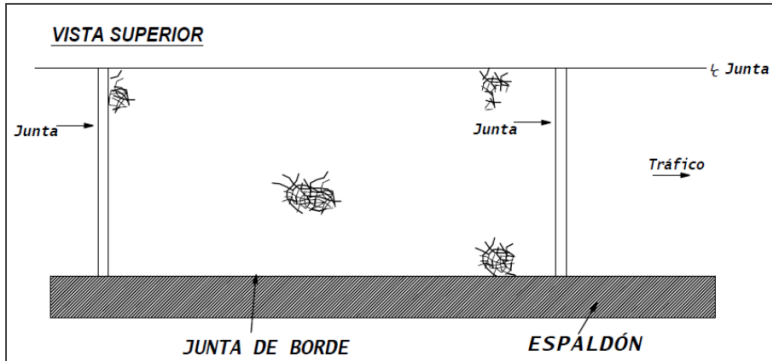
Esquema Grieta de Malla- Pavimento Rígido
